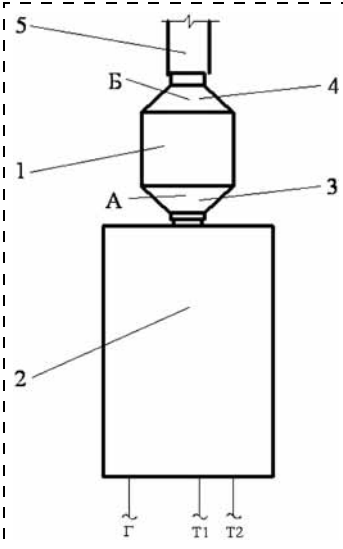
Монтаж насадки на дымовую трубу теплогенератора
